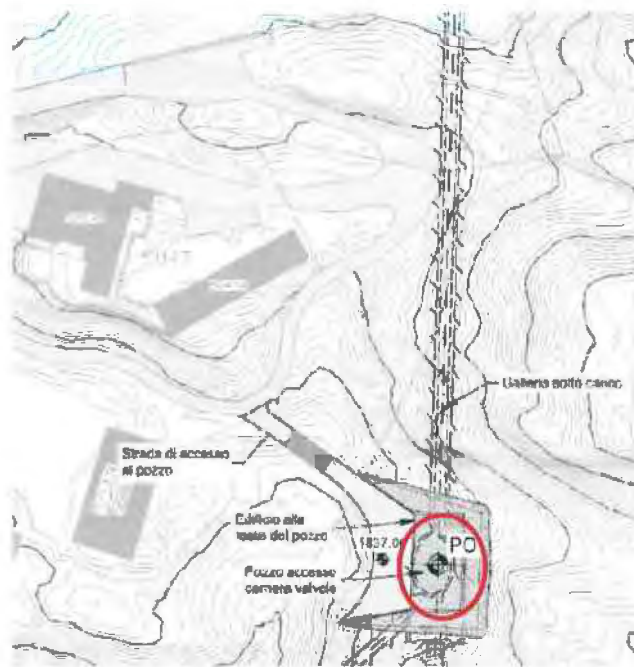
Disposizione generale del pozzo verticale quale accesso alla camera valvole secondo il progetto definitivo
